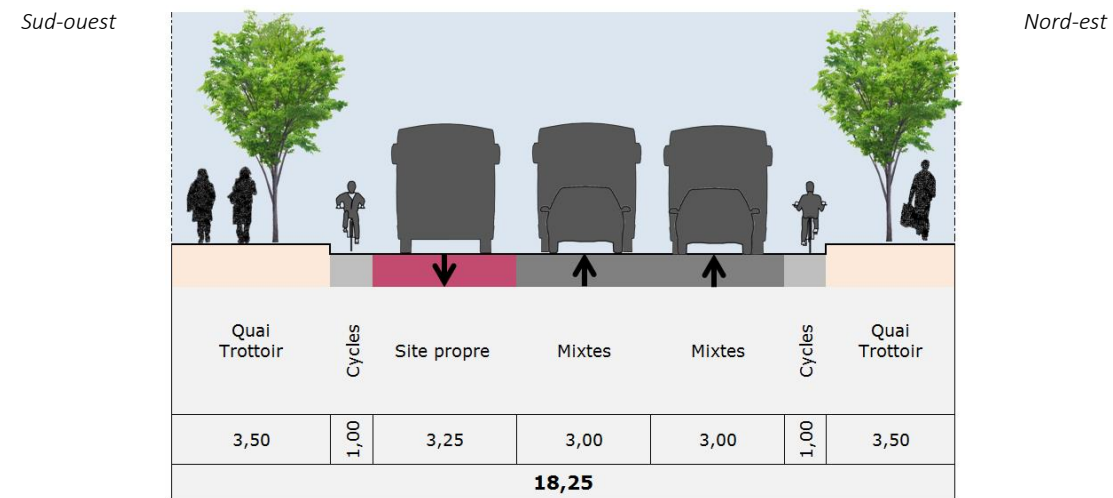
Coupe type sur le boulevard Maurice Berteaux - Variante 1
